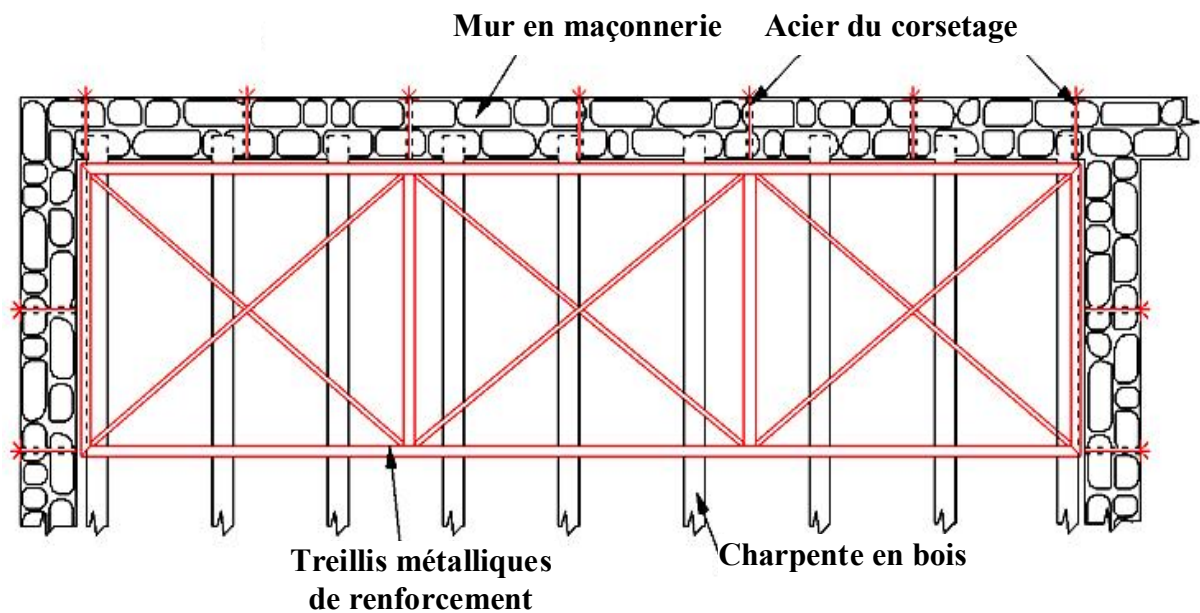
Renforcement du plancher d'un ouvrage en maçonnerie
